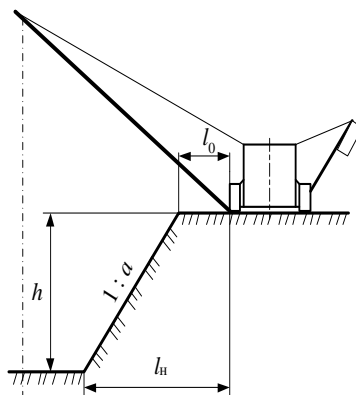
Схема безопасной установки стрелового крана у бровки котлована
